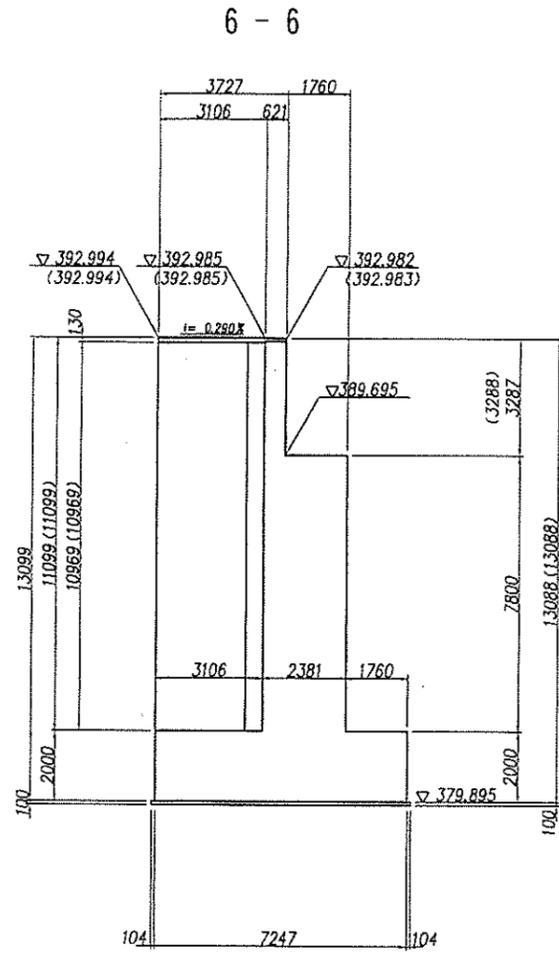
Plano Estructural de La Base del Puente A1 (2)
